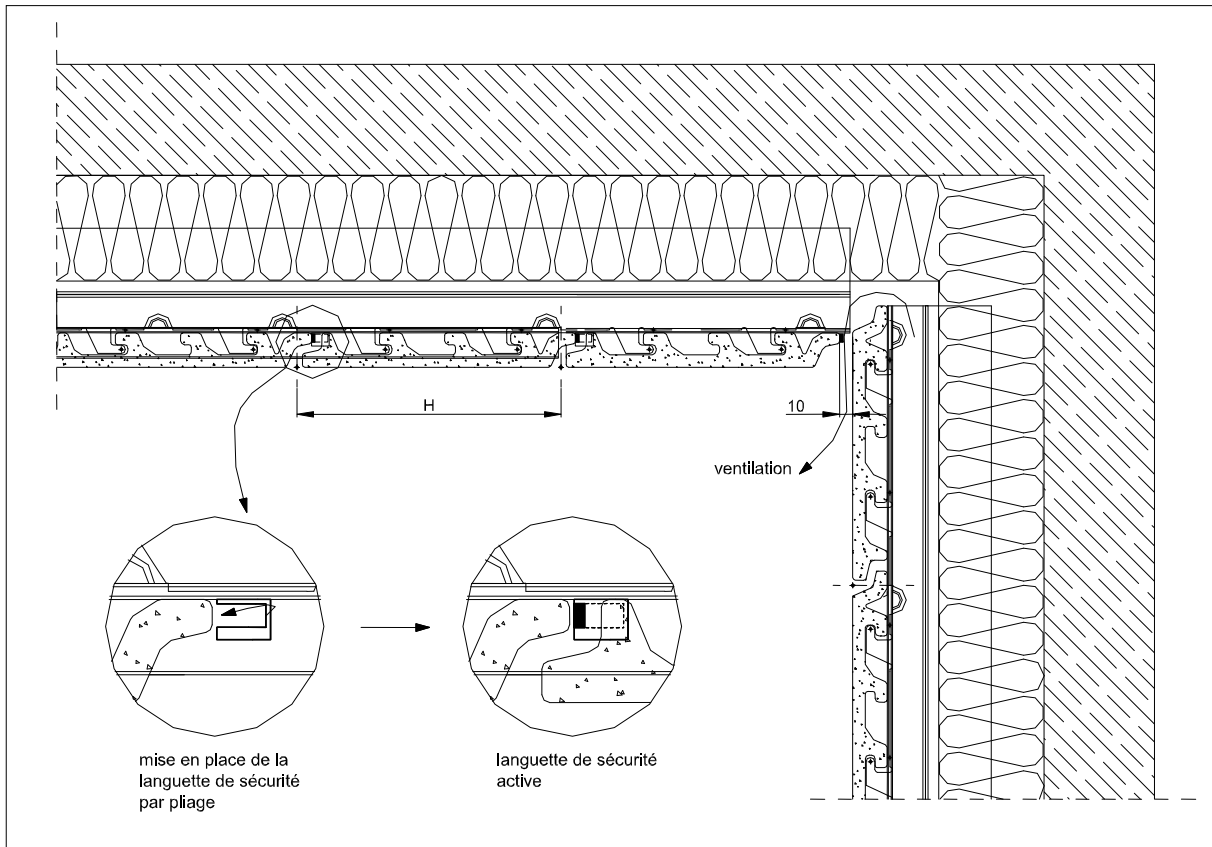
Principe de pose en sous-face - coupe longitudinale – Ossature Aluminium
